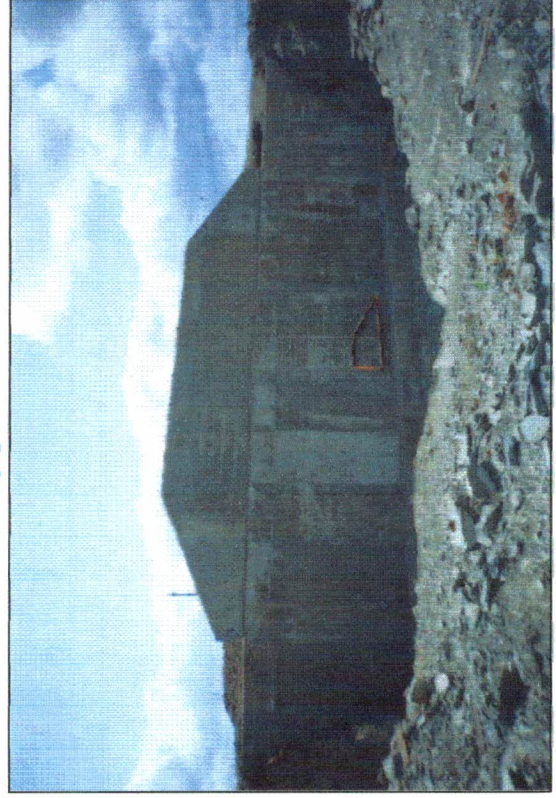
Vista do muro de contenção estaca 91, mostrando a junta fungeband.
